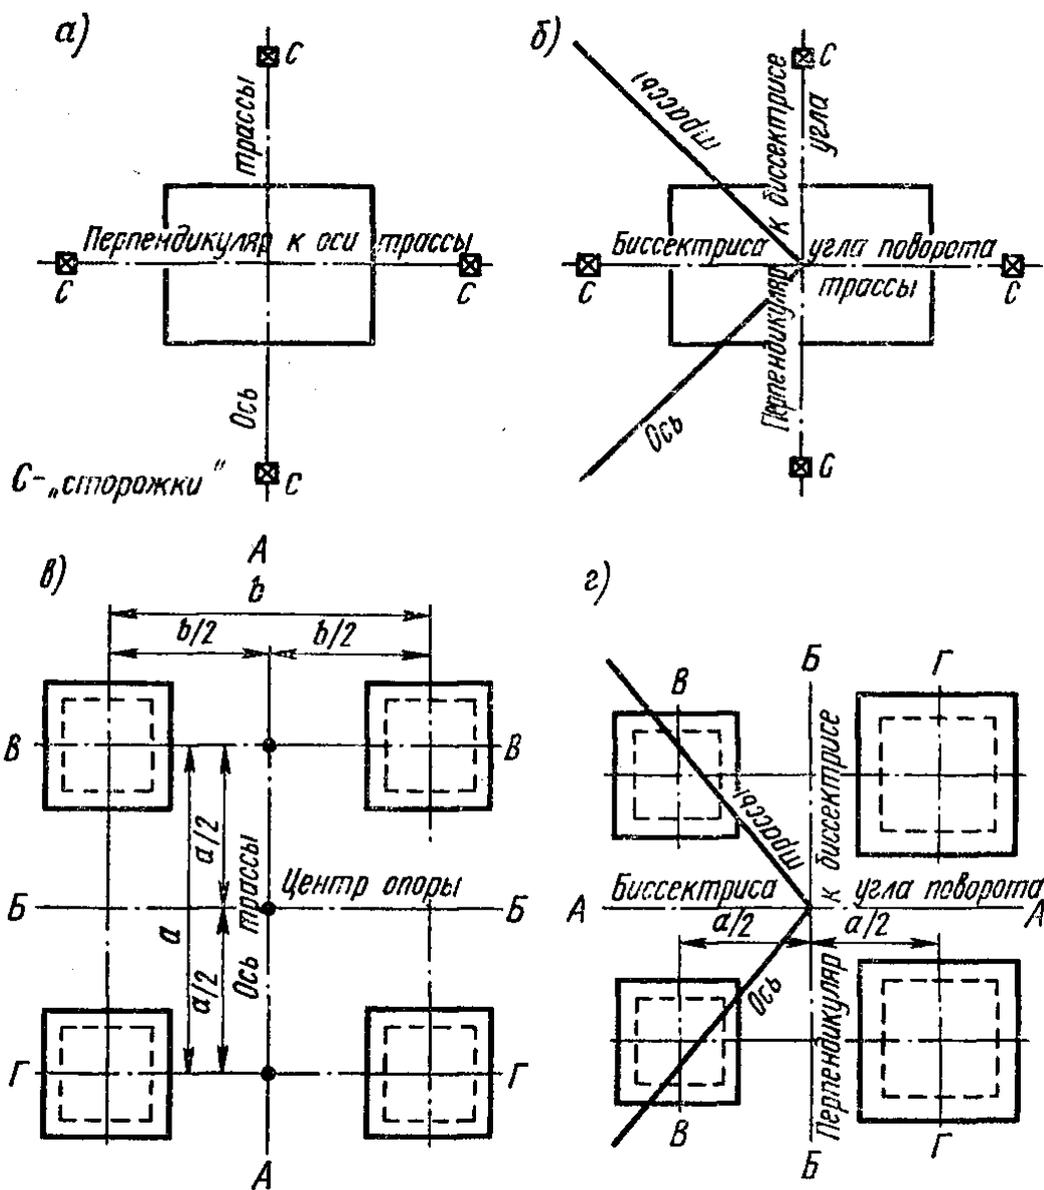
Схема разбивки котлованов под установку опор: *а* - одиночный котлован; *б* - под А-образную угловую опору; *в* - под фундаменты четырехстоечной опоры; *г* - то же, угловой опоры
